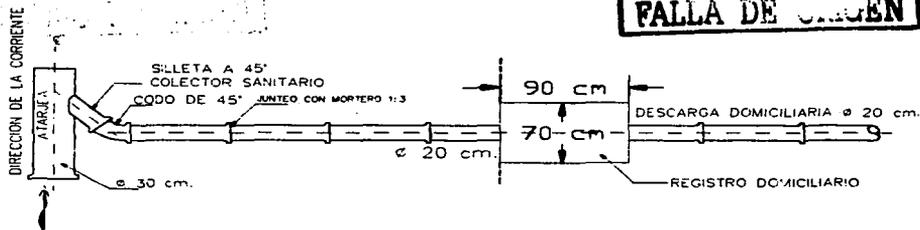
"Detalles constructivos de la red de alcantarillado"
